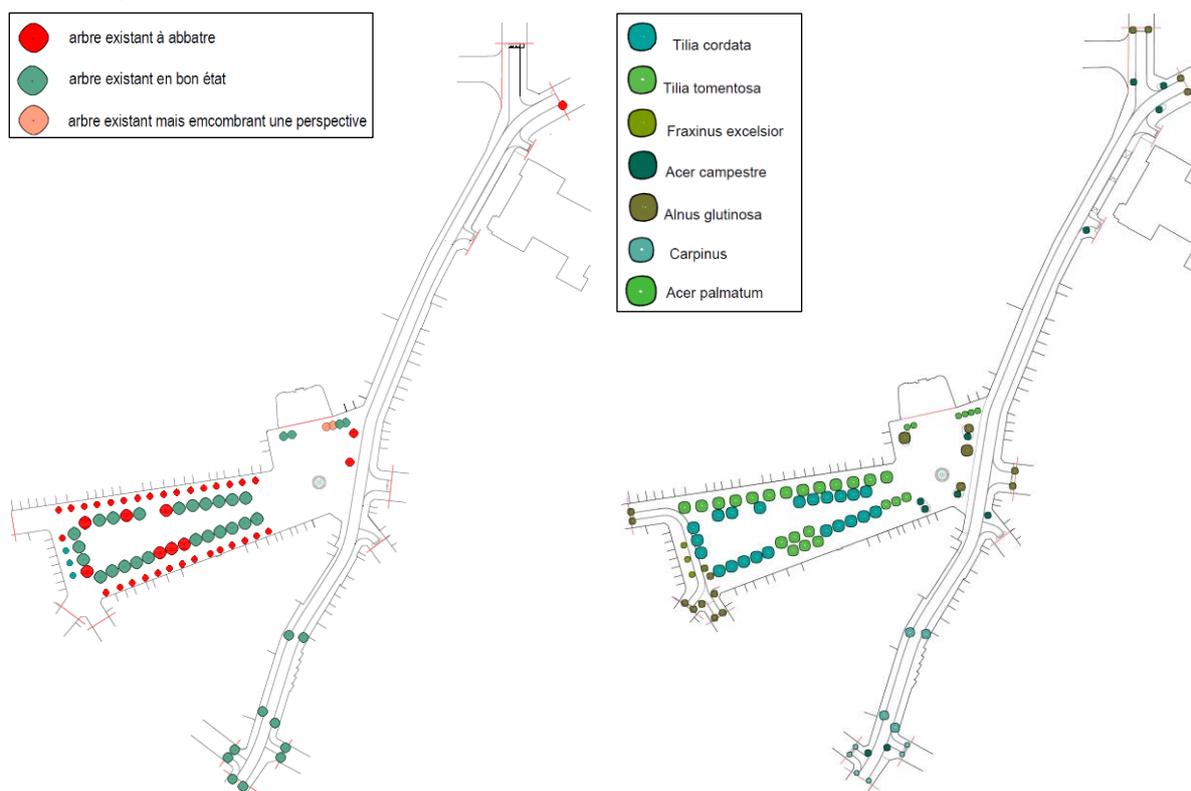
Plan d'abattage (gauche) et plan de plantation (droite) (A-Practice, 2021)
